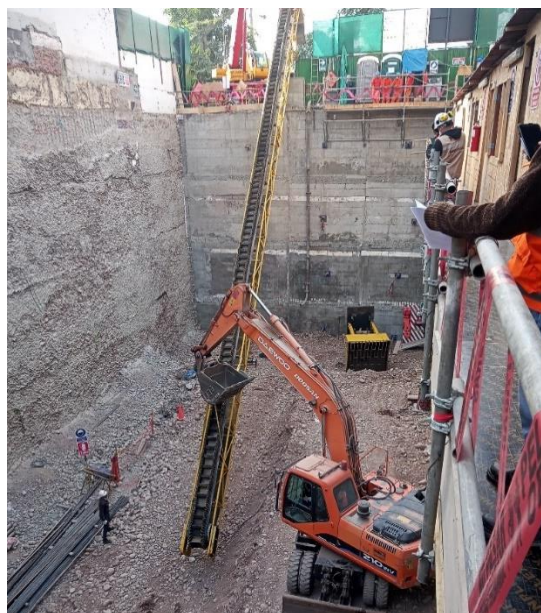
Izaje de la faja transportadora armada con ayuda de la grúa y la excavadora
